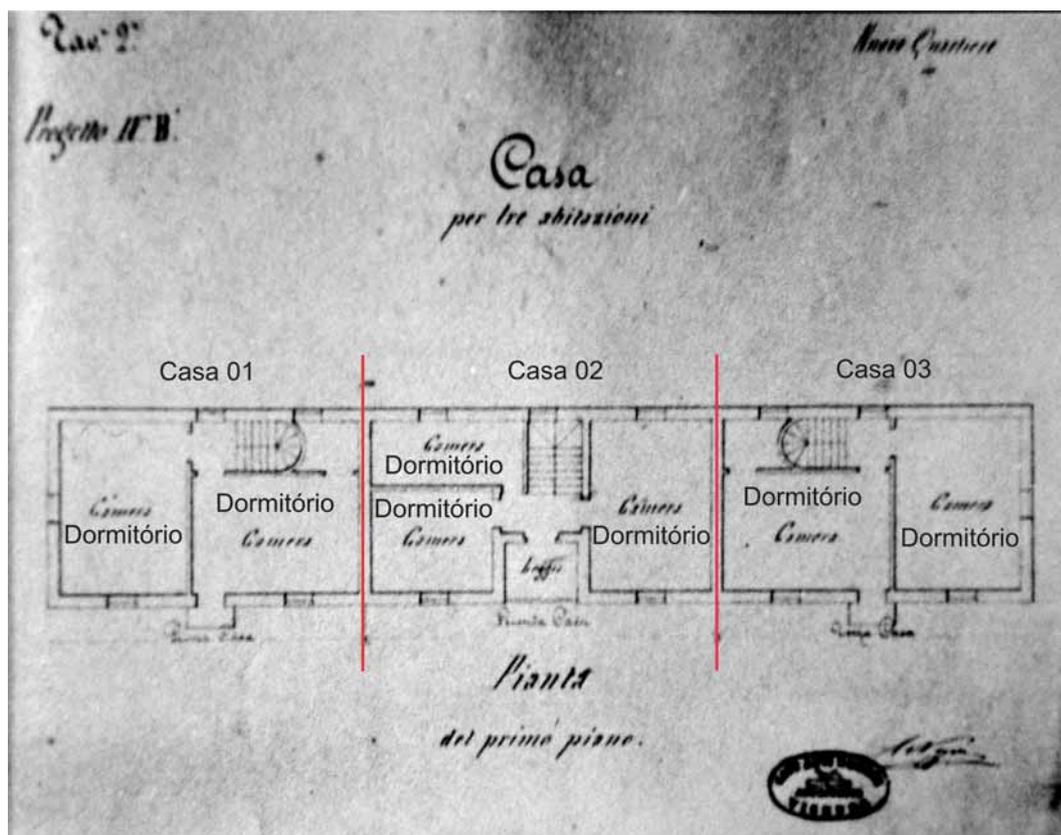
Planta baixa do segundo pavimento da casa tripla do Lanerossi
